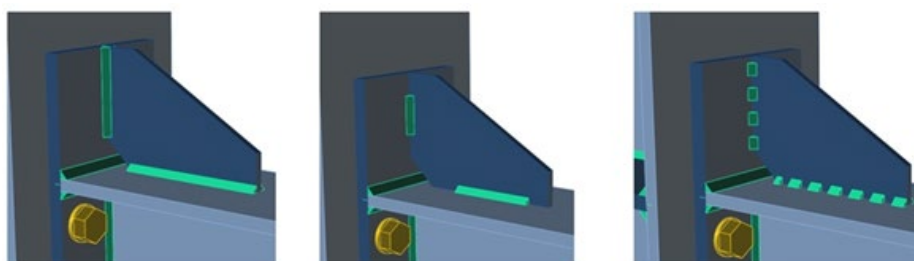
Виды сварных швов. Слева направо: непрерывные, частичные и прерывистые.
